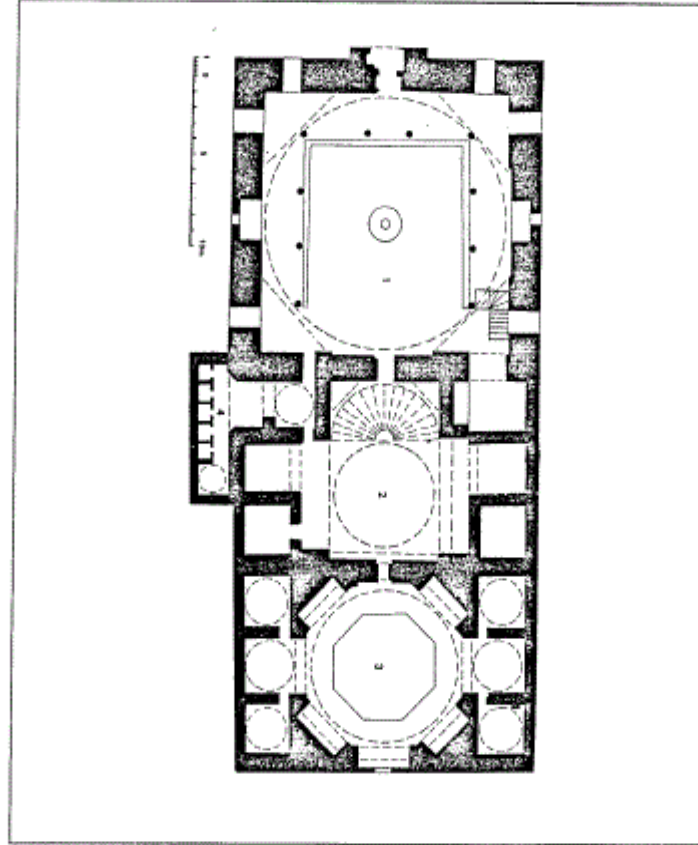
مسقط أفقي لعمارت نيلوفر خانون بازنيق (عن : إيفردى) .
